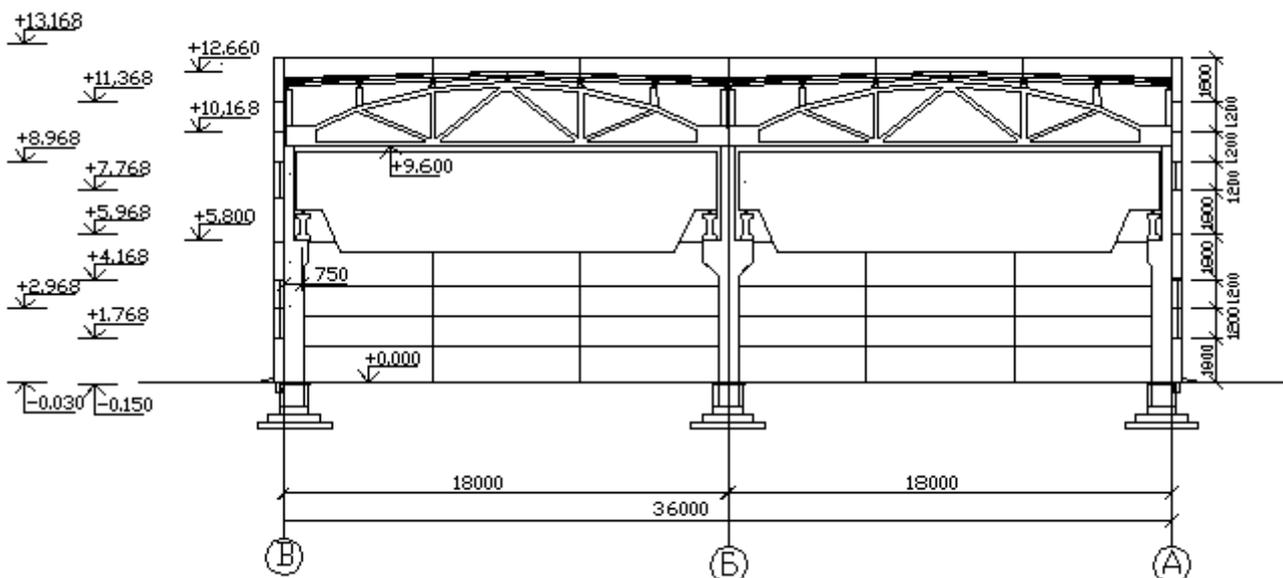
Поперечный разрез двух пролетного пром здания с мостовыми кранами.
